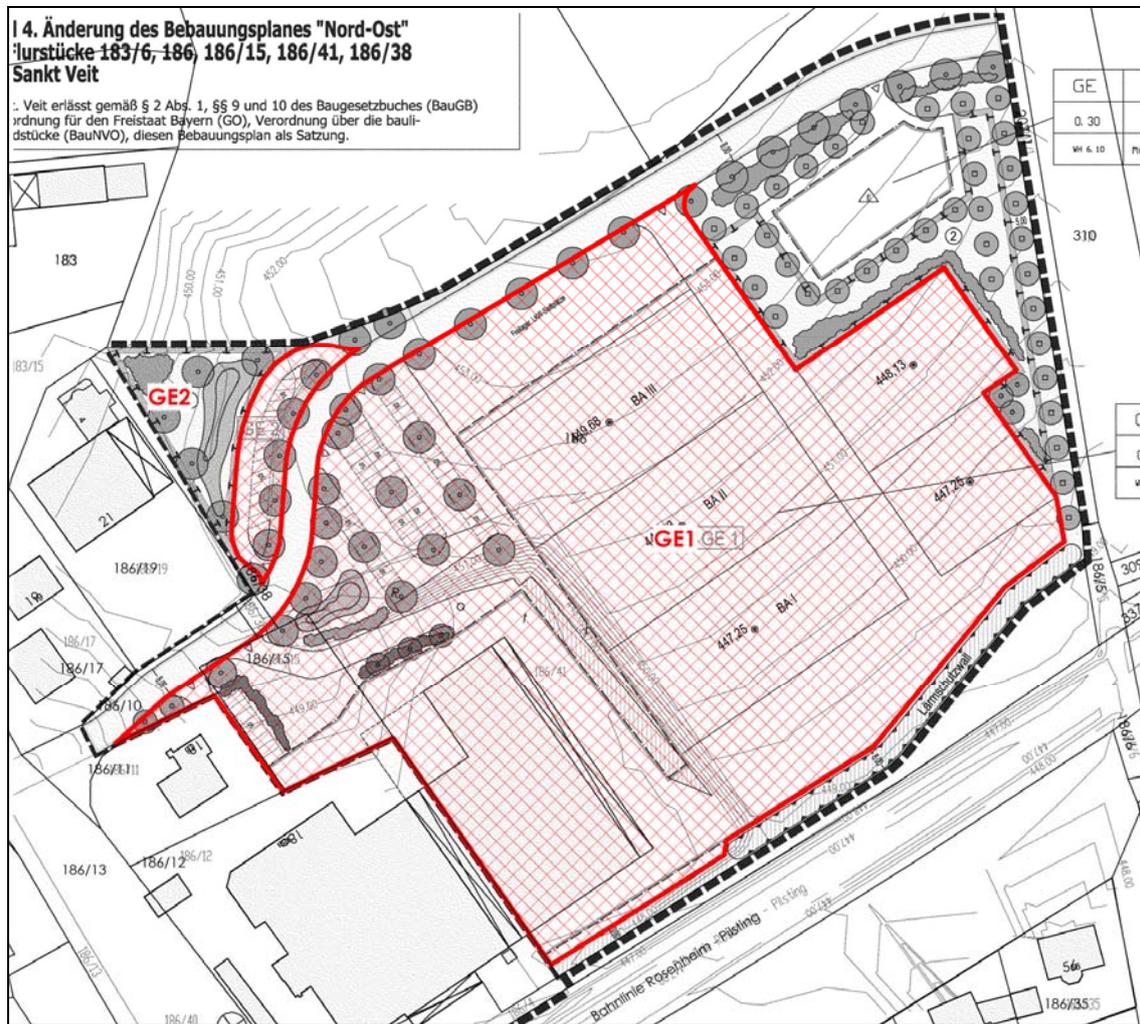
Lageplan mit Darstellung der Emissionsbezugsflächen
